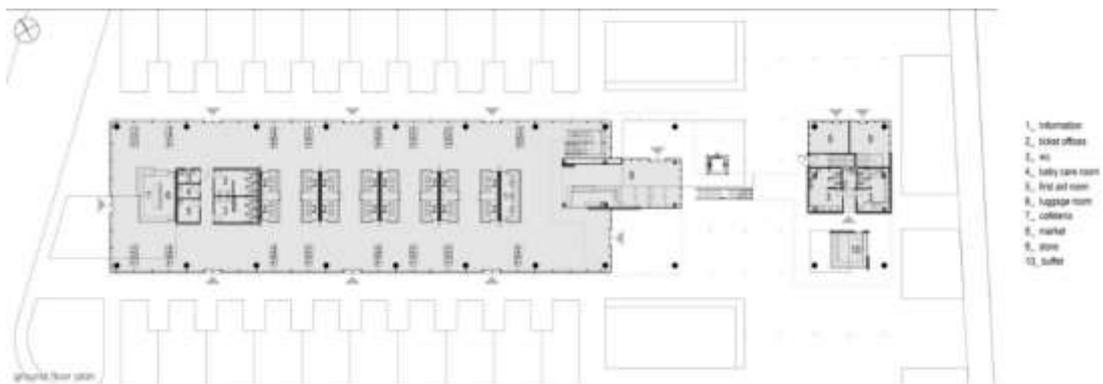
Planta primer nivel de la Estación de Autobuses Lüleburgaz.
